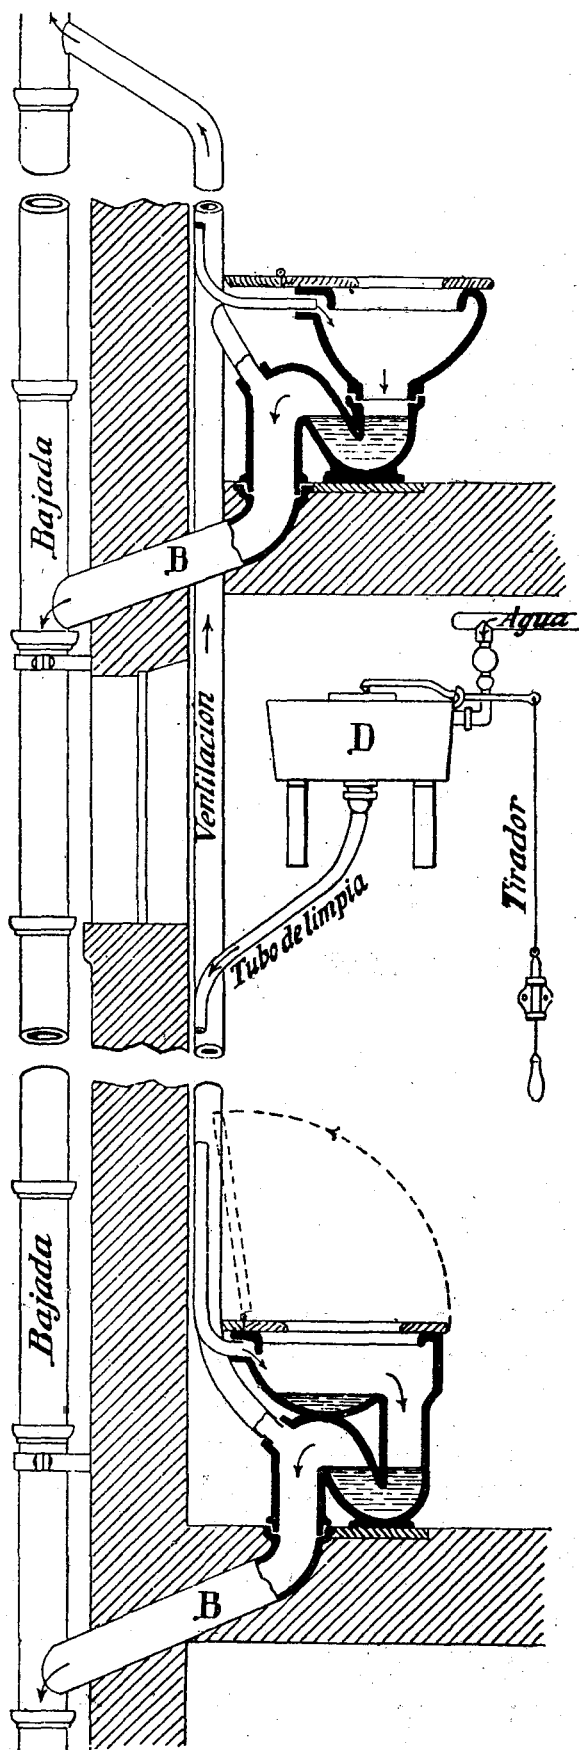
Conjunto de una instalación de retretes con sifón.
